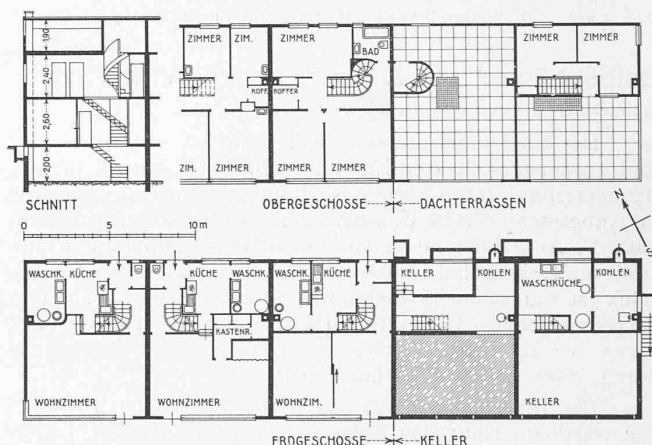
Grundrisse und Schnitt des Reihenhauses. — 1:400.
